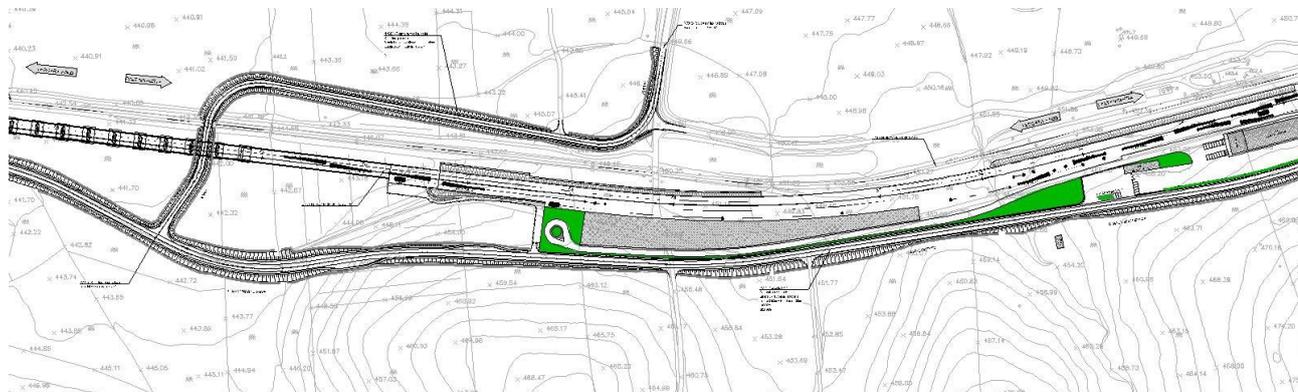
NV01 stralcio planimetrico da km 2+150 a km 3+450
